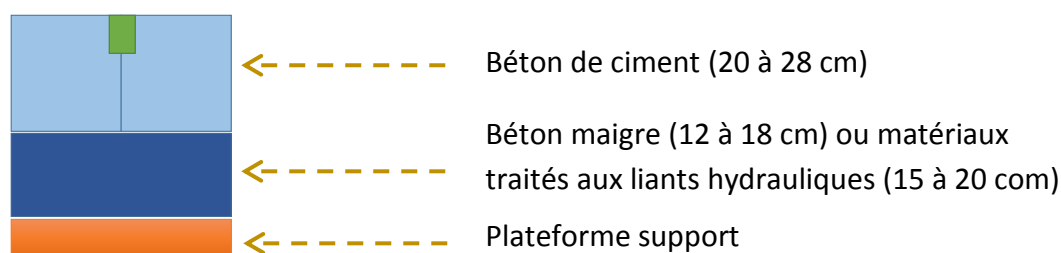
Chaussées à dalles non armées et non goudonnées
